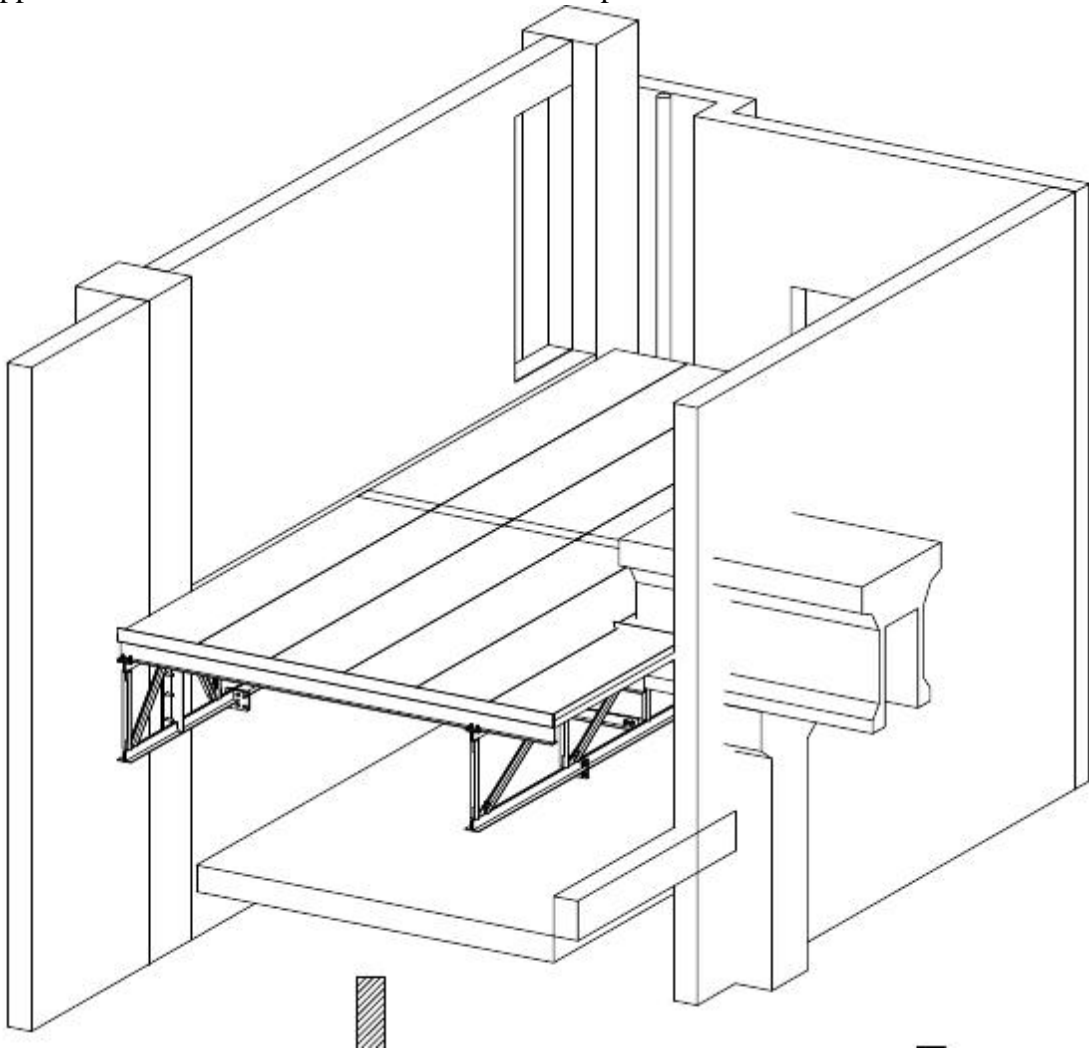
Particolare di A.2010.a.sa.T01 - Progetto della struttura metallica - Vista assonometrica soppalco
